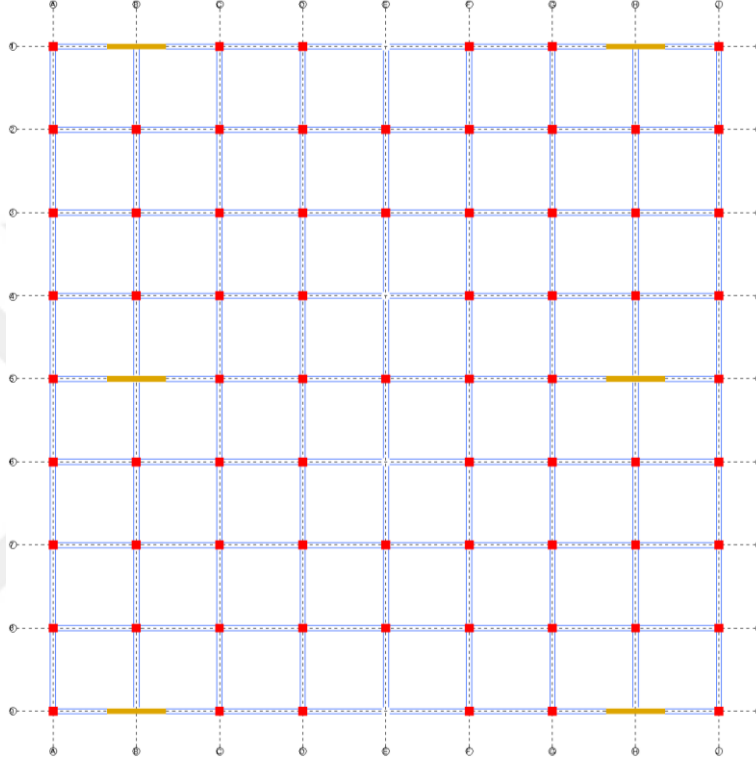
Model 4.2 'ye Ait Kat Planı
